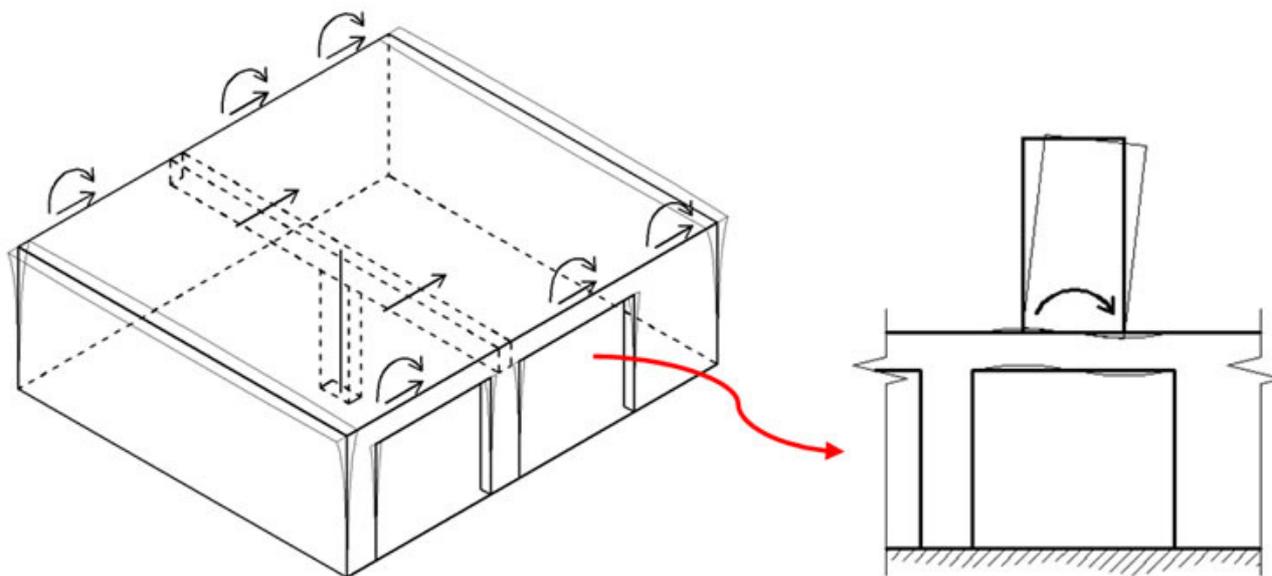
Dettaglio dello spostamento in sommità della parete in muratura, dovuto alla deformazione flettente della trave dell'apertura dei garage alla base della parete stessa.
